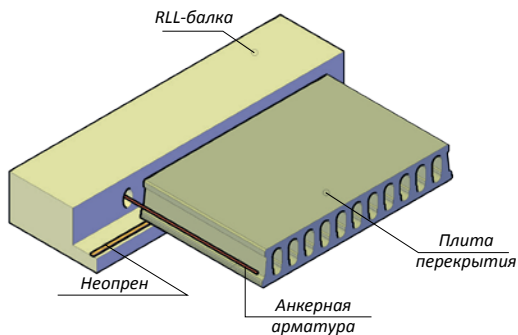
Соединение RLL-балки с многопустотной плитой перекрытия.
